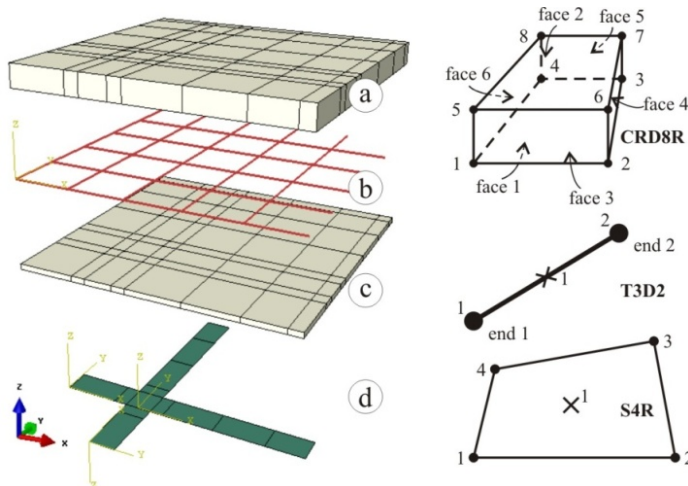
Geometria plăcii și elementele finite: a) volum de beton; b) armătura din oțel; c) acoperirea din beton; d) platbande CPAFC
